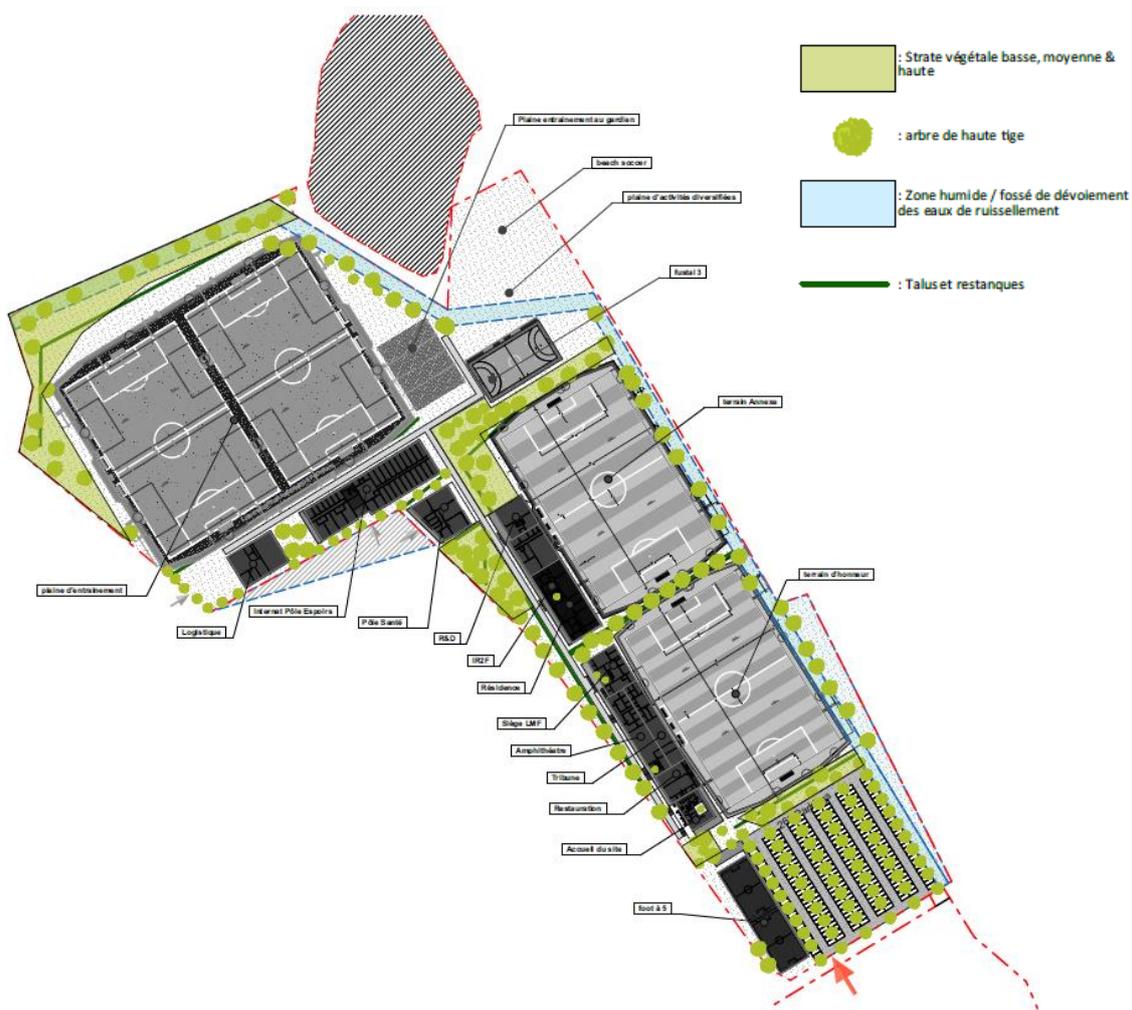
Plan d'aménagement prévu sur le site de Château-Blanc
